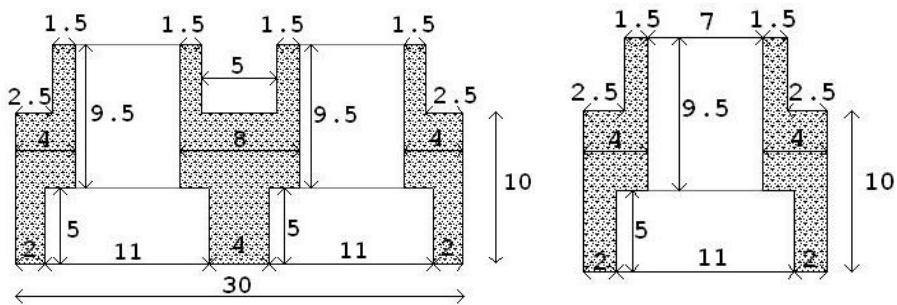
Figura II.- Dimensiones de la pieza básica del Sistema Assemblack, cm.
